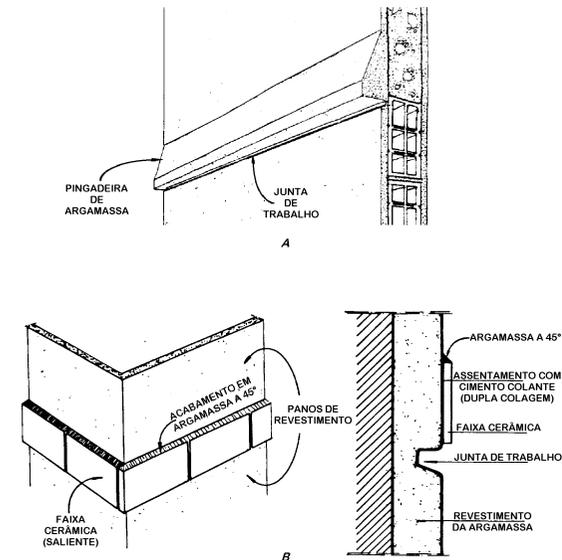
Detalhes da fachada: pingadeira e faixa de cerâmica ou pedra
